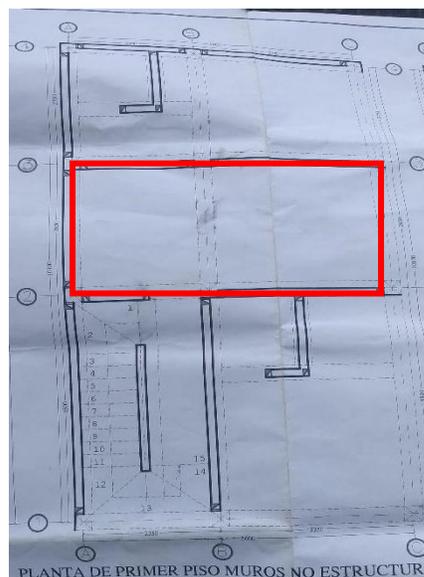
Lugar propuesto para garaje, donde se construye unidad comercial adicional.
